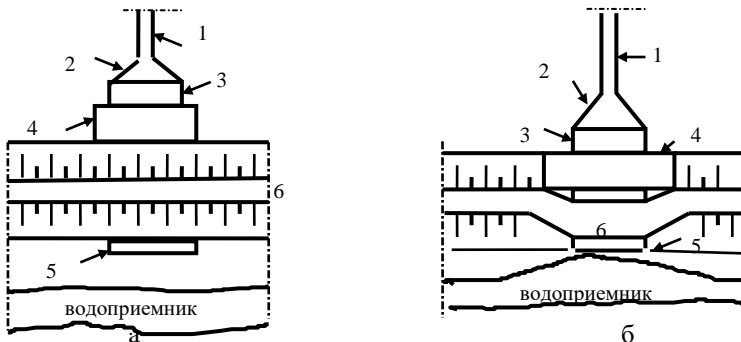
Схемы гидроузлов осушительных насосных станций:
